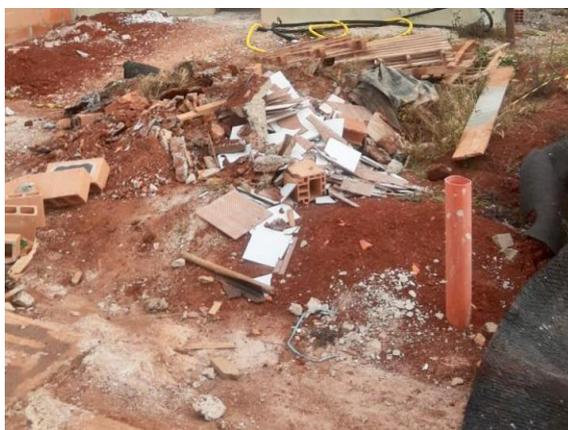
Canteiro da Construtora “C” sem separação e armazenamento de resíduos. Fonte: Construtora “C” (2021)
